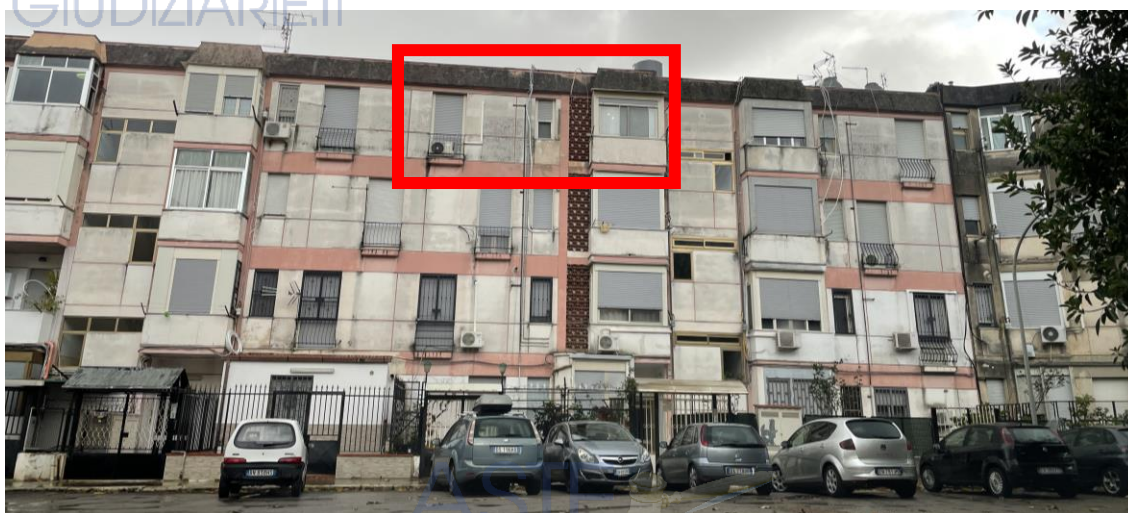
Il prospetto dell'immobile su Largo Ippona, al terzo piano si trova l'appartamento
